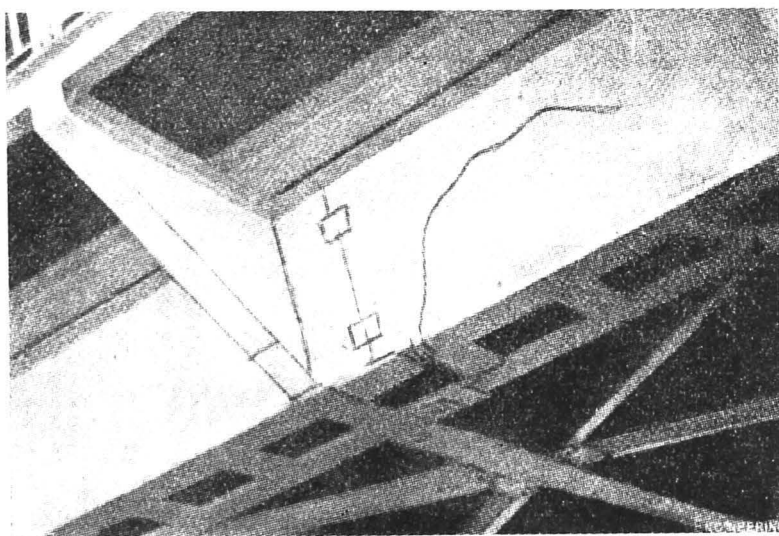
Podul Hasselt. Fractură la talpa inferioară.
